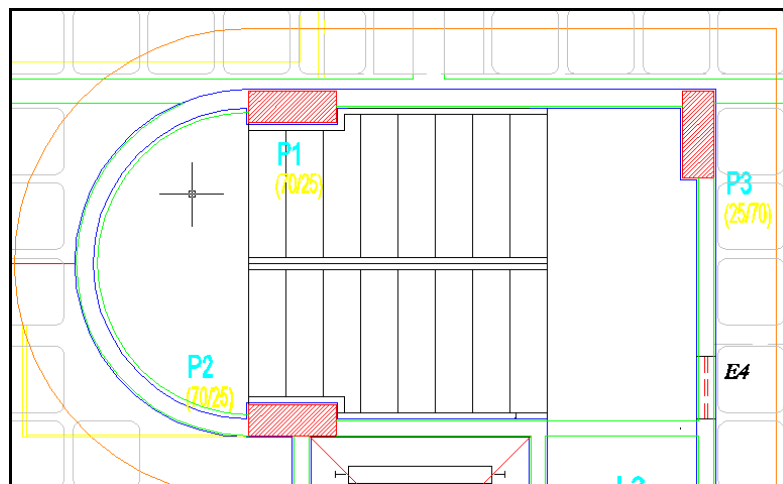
Pilar invadindo a escada e saliência da viga entre P1 e P2 (Pav. Ground)
